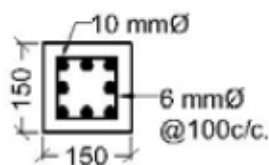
Coupe sur poutres et poteaux et leur ferrailage.
